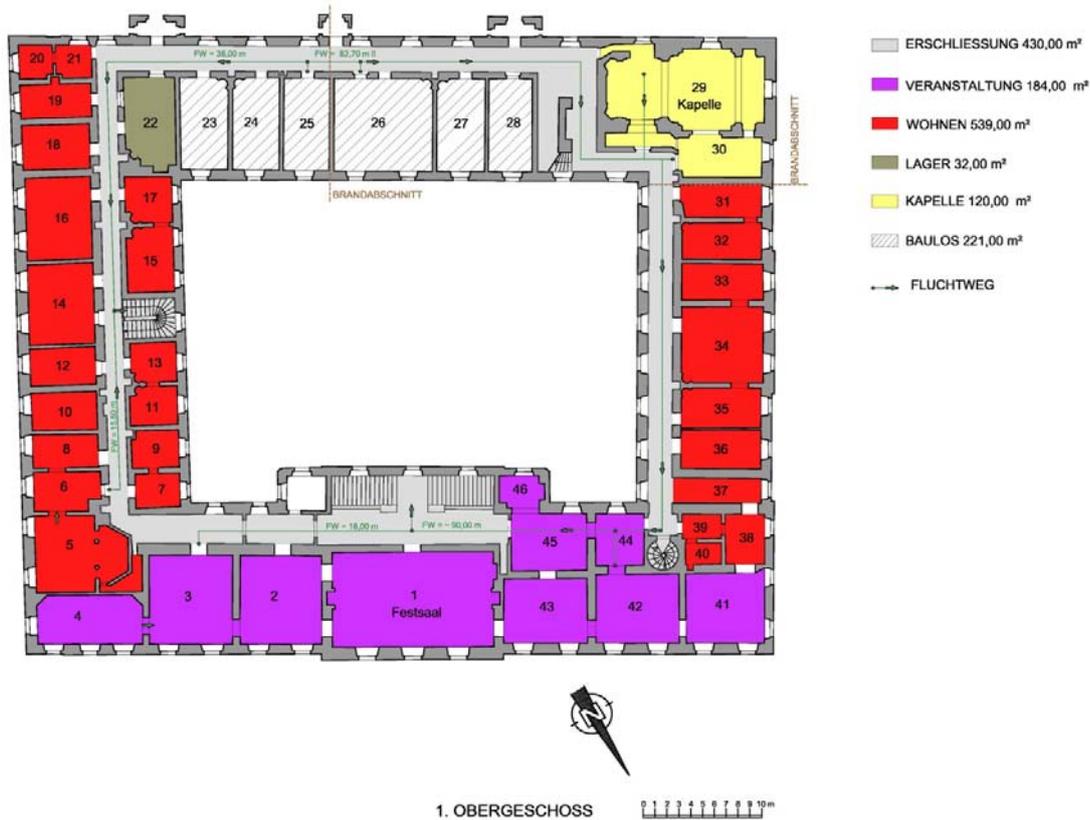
zeigt den Grundriss des Schlosses Ebenthal
